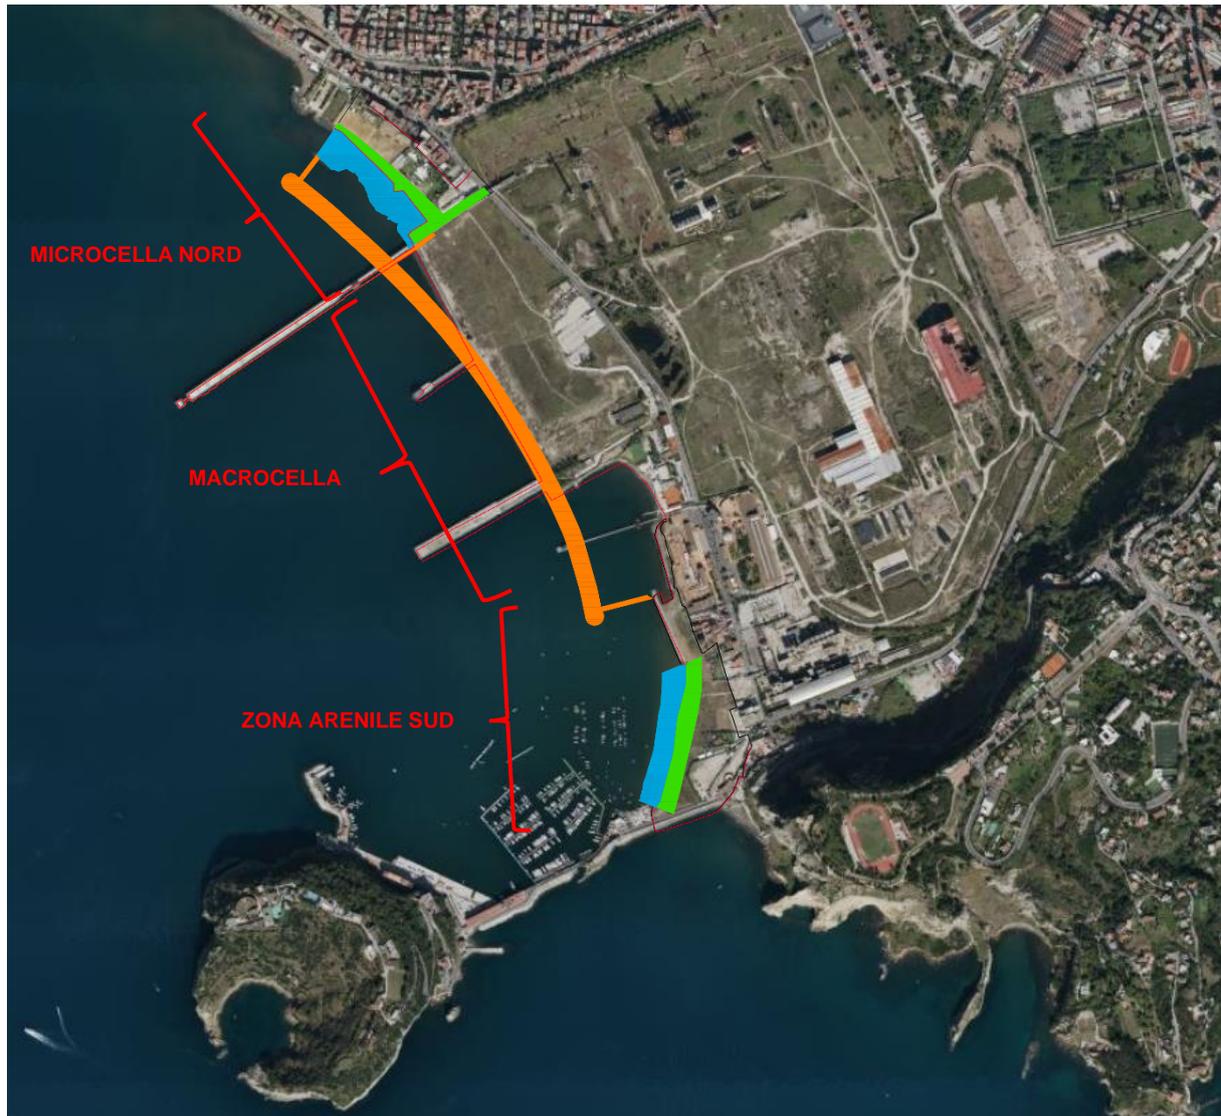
Inquadramento area di intervento e sovrapposizione con planimetria di progetto
